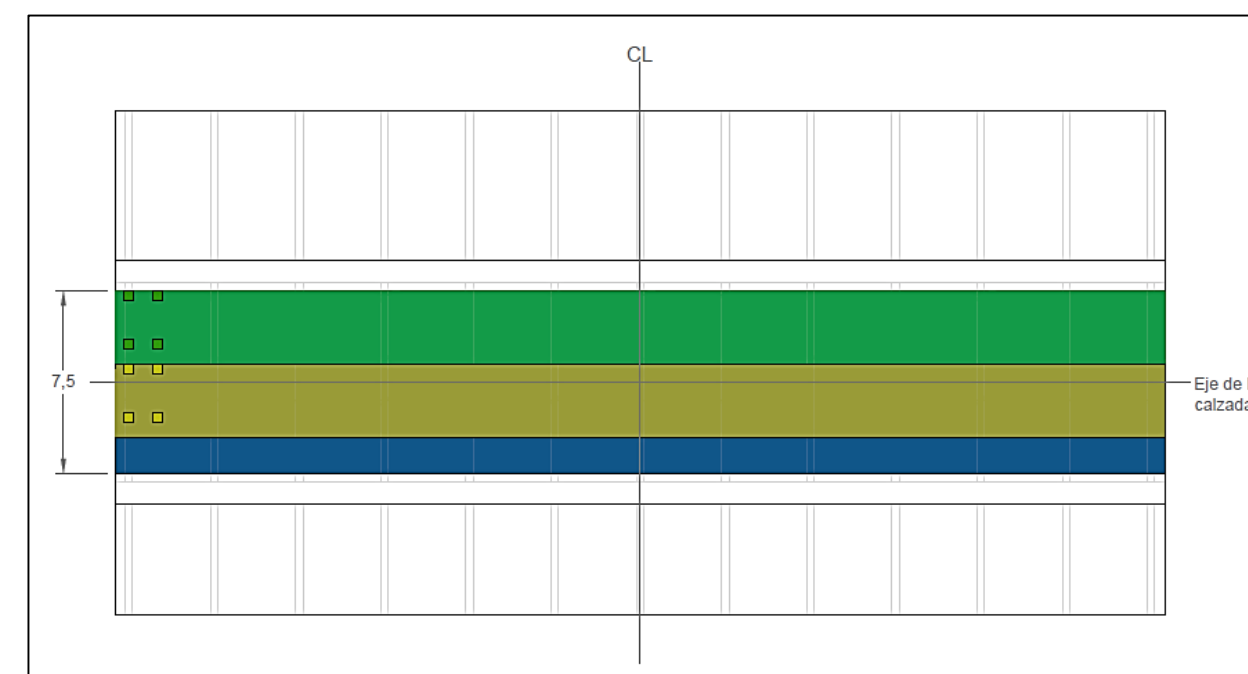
Caso 4 de sobrecargas de uso - Planta. Elaboración propia con AutoCAD
